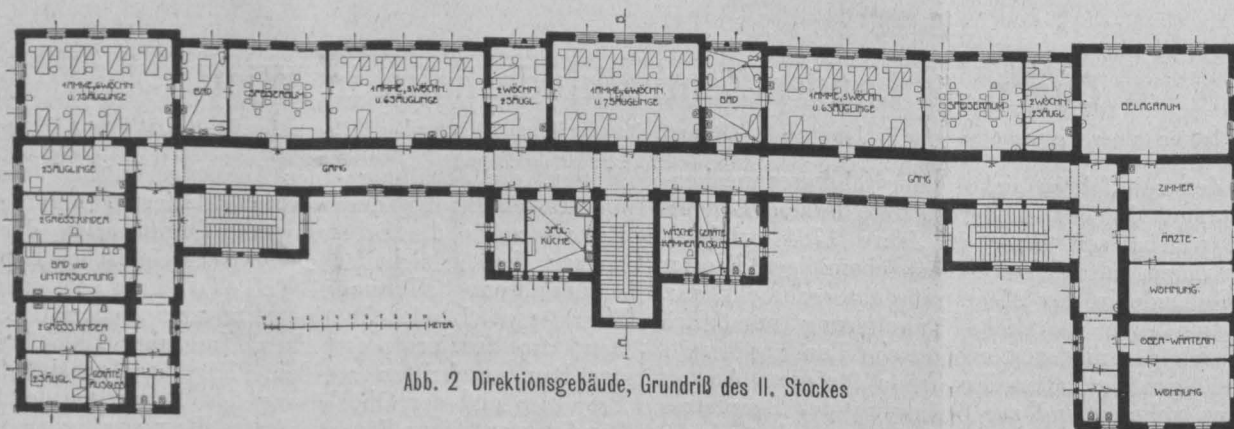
Direktionsgebäude, Grundriß des II. Stockes
